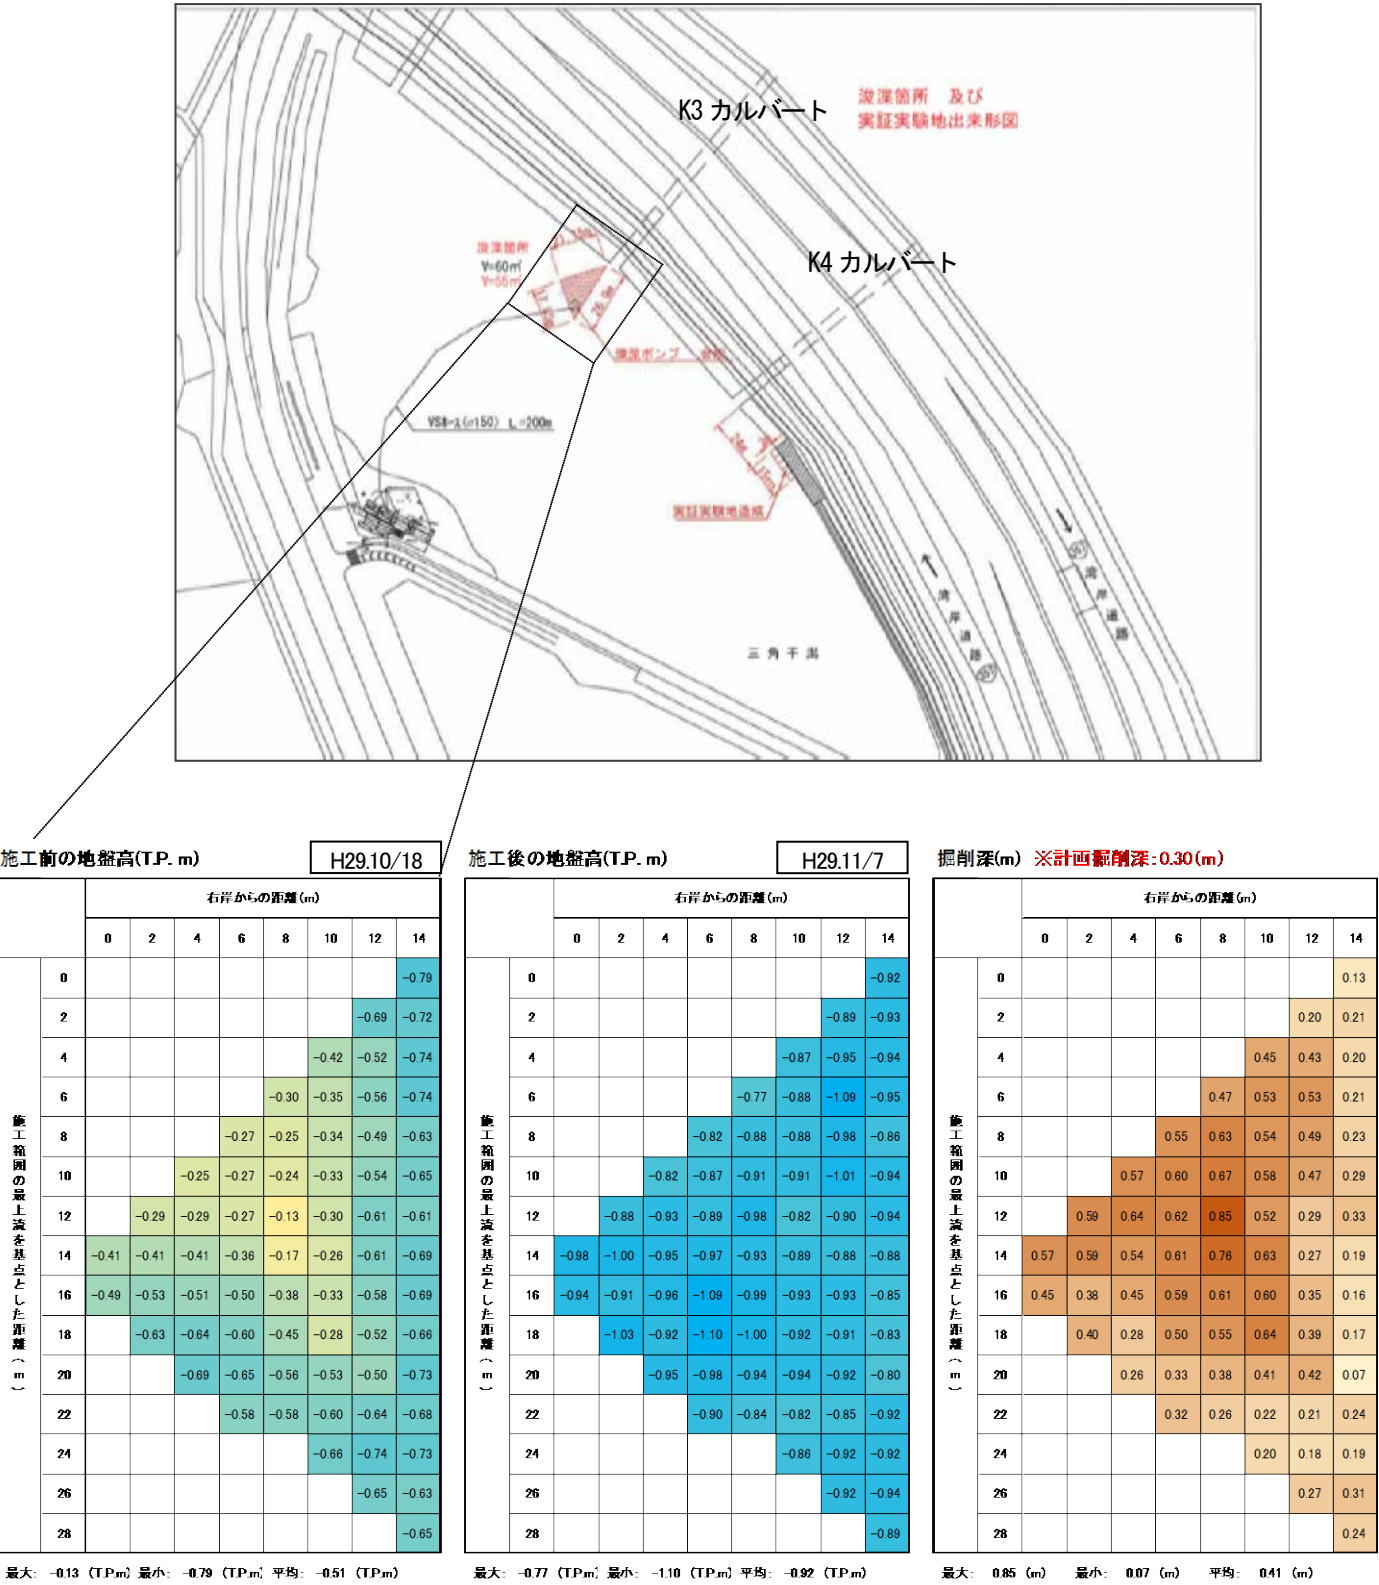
施工の位置と施工前後の地盤高の変化(単位:m)
